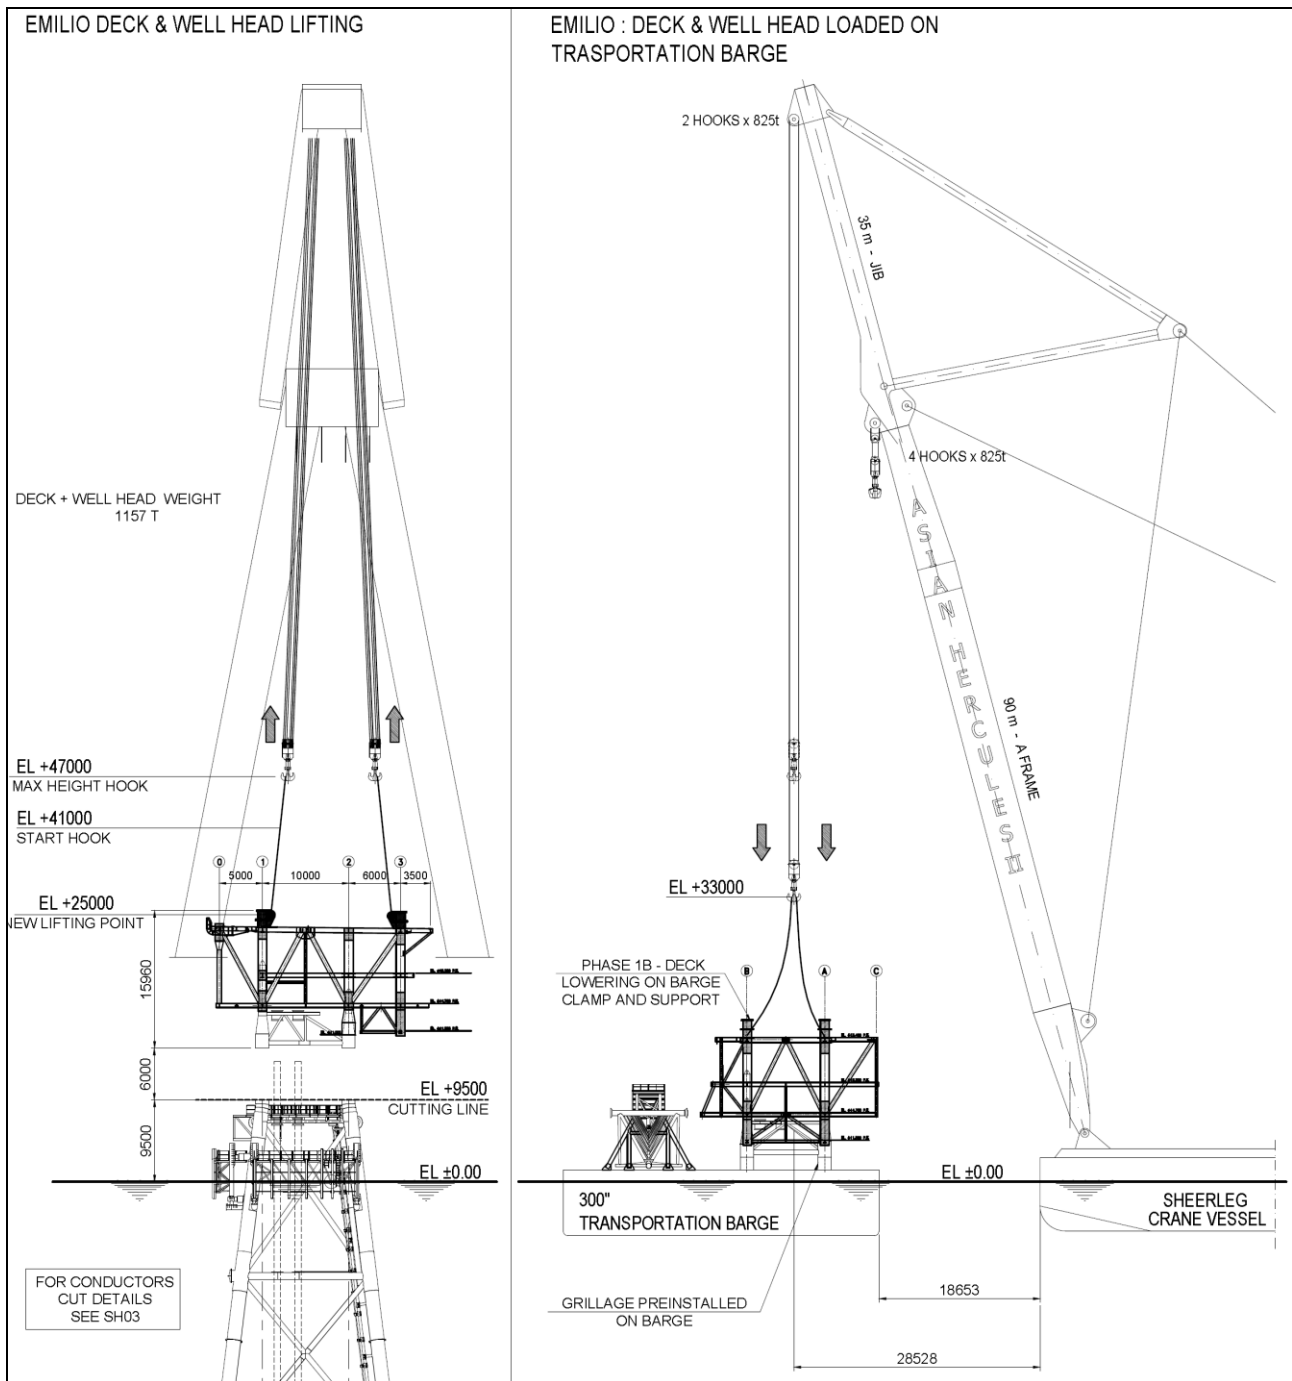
Rimozione e Sollevamento Deck e Modulo Testa Pozzo
